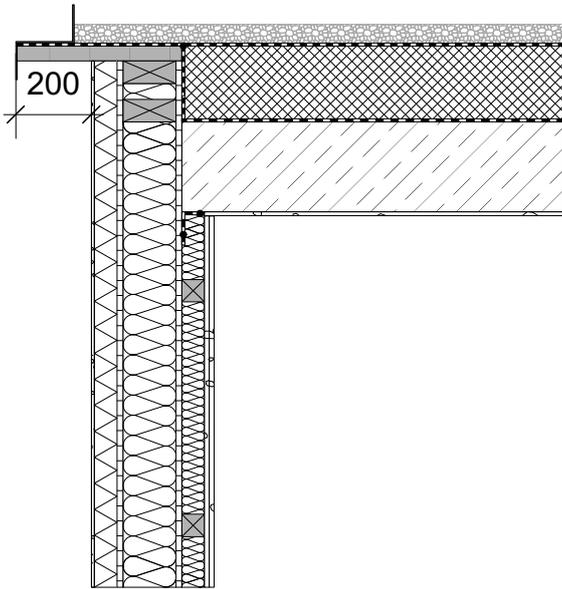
Anschluss Flachdach DA1 - Außenwand WA1-3 ohne Attika
